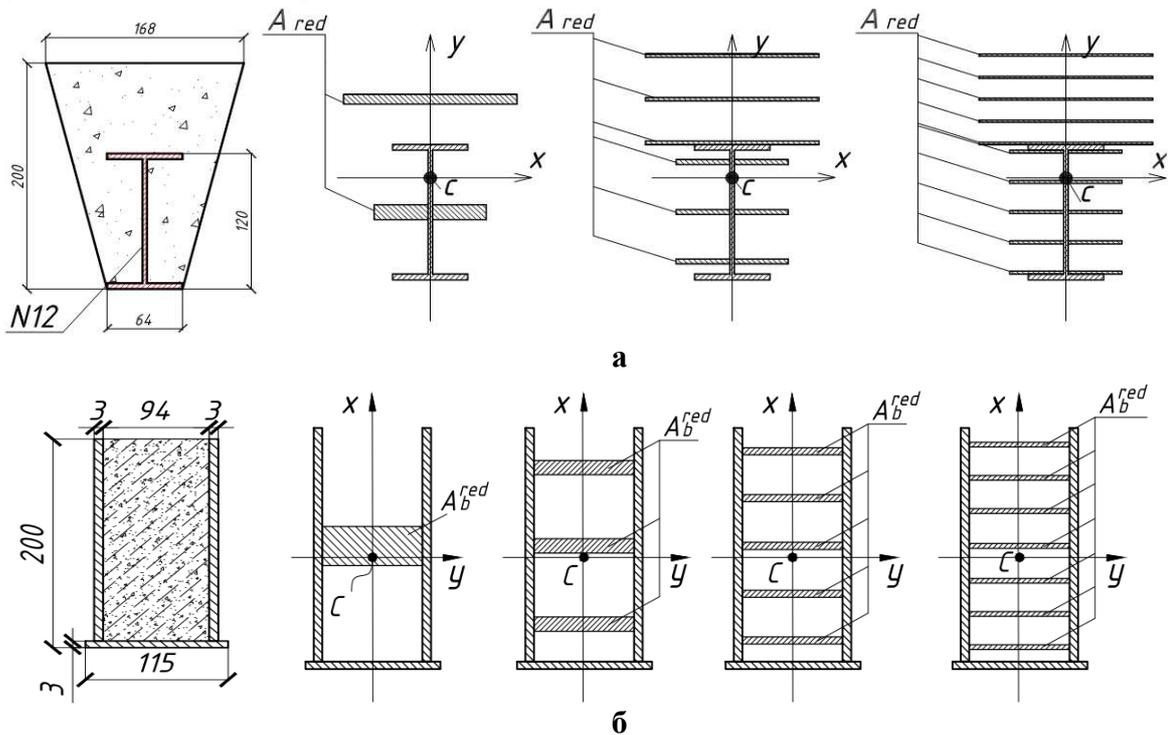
Розрахункові схеми приведеного перерізу: а – трапецієвидний ригель із жорстким армуванням двотавром (серія зразків БТ); б – сталезалізобетонний ригель із зовнішнім листовим армуванням (серія зразків Б-І, Б-ІІ)
